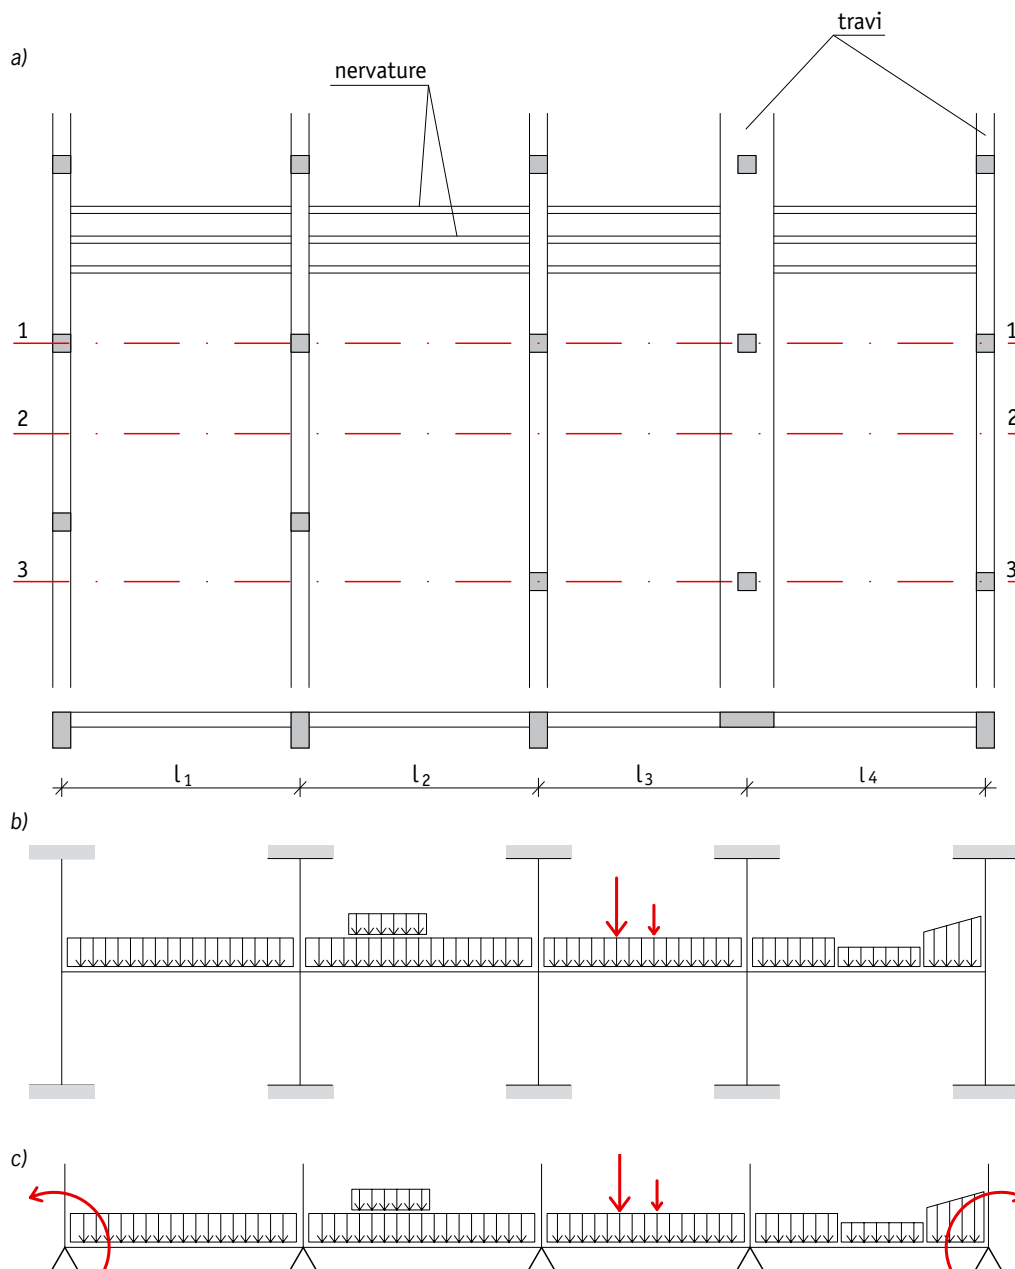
Solaio in continuità su più campate (a); schema statico a telaio parziale (b); schema statico a trave continua (c).
